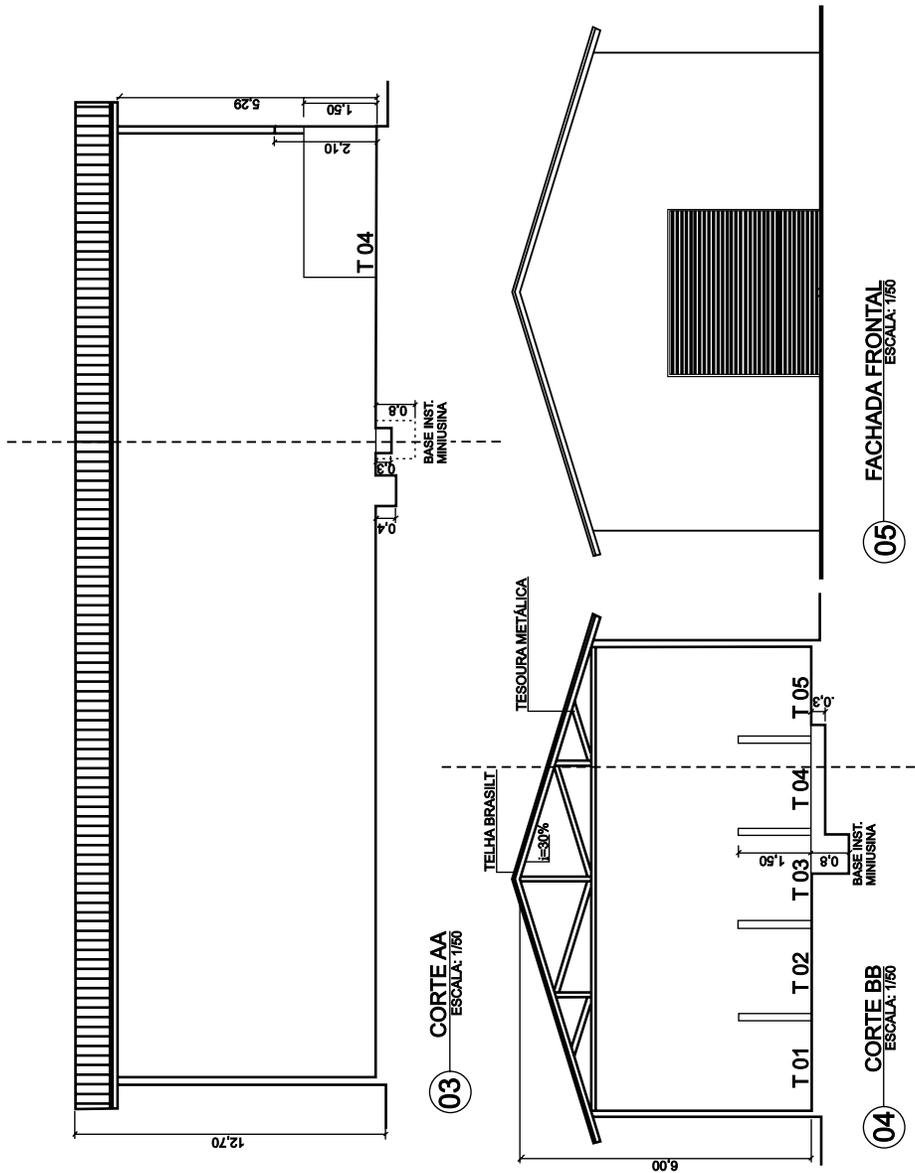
Planta em corte e fachada do galpão para instalação da miniusina (em metros).
